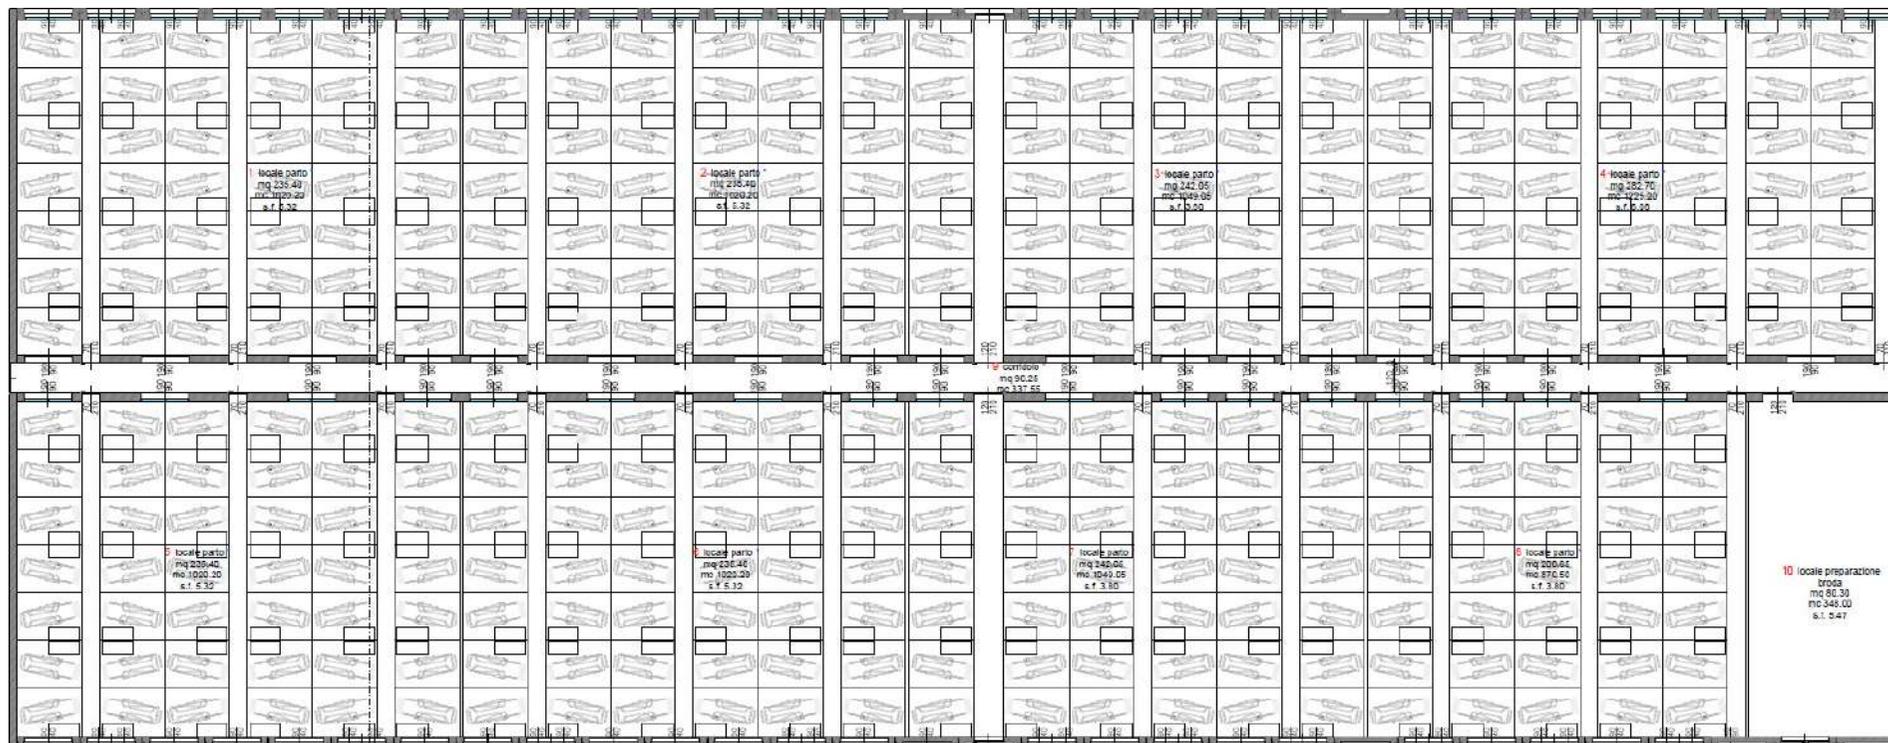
planimetria del capannone E12 - da arch. Bergamo
